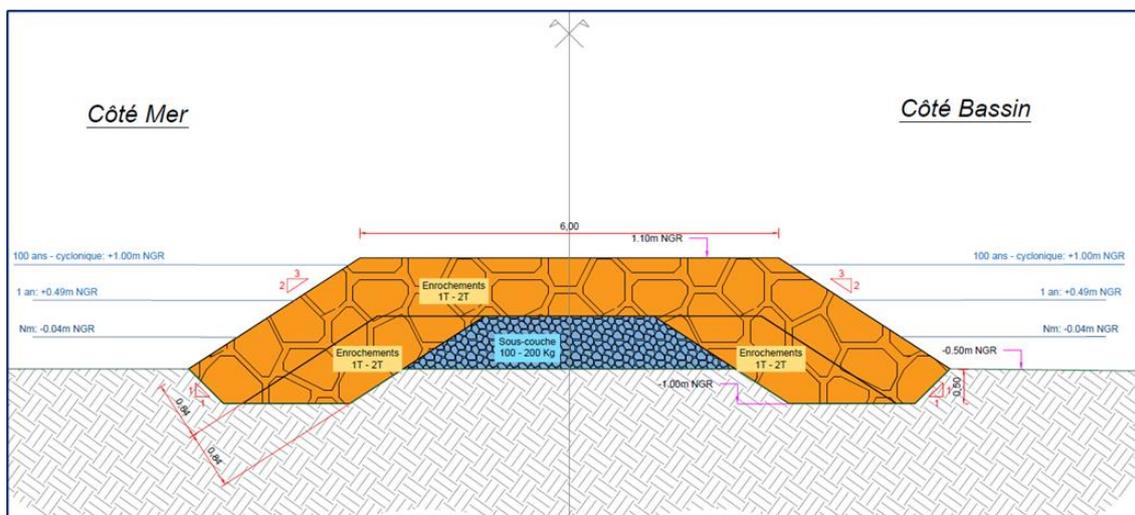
Coupe type de l'enrochement – Tronçon de retour
